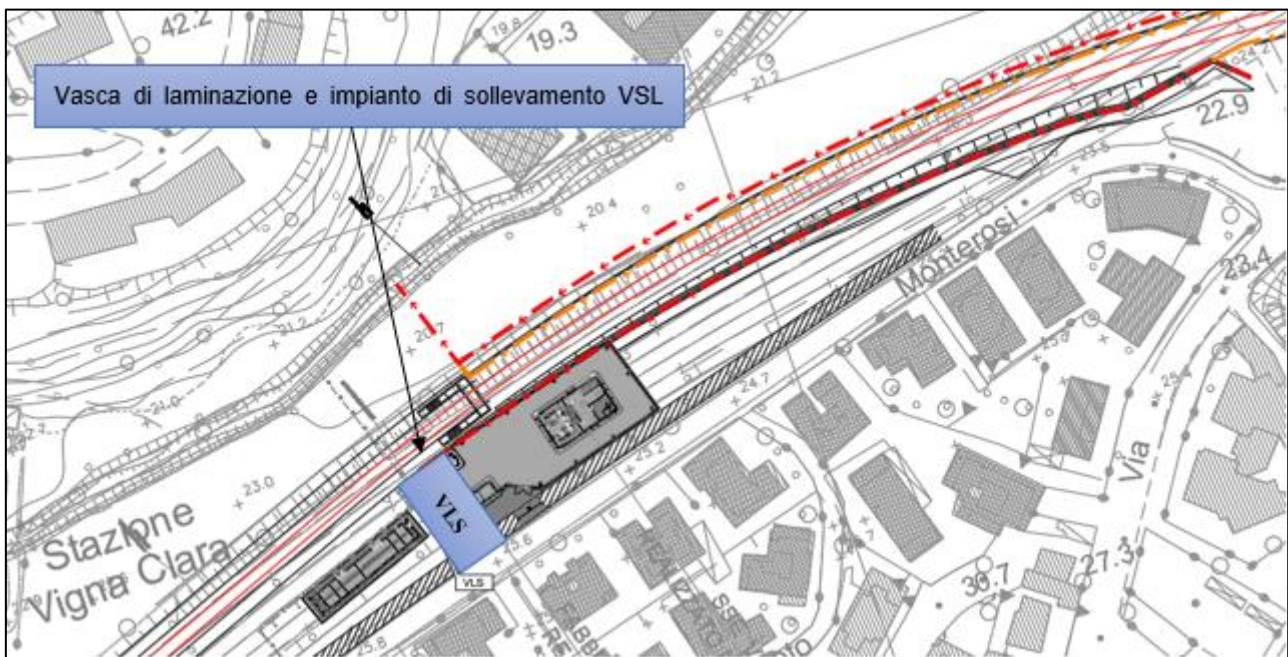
Stralcio planimetrico stazione di Vigna Clara
